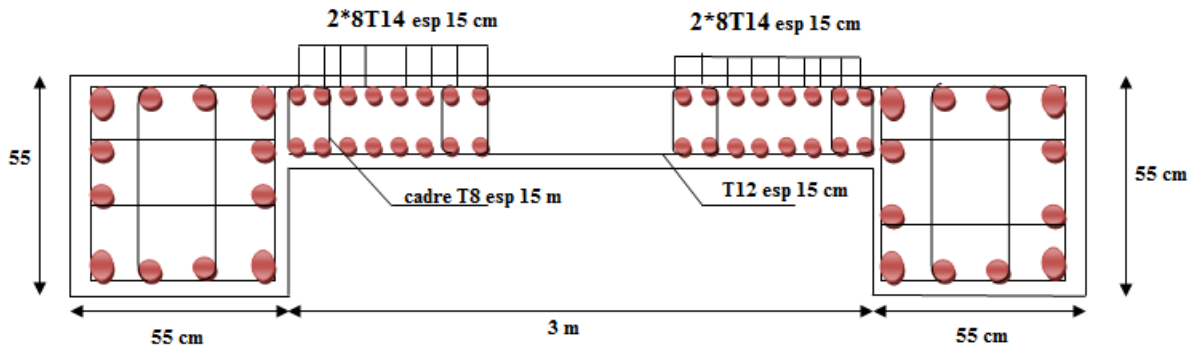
Détail de Ferrailage du voile (V2- V2'), coupe horizontale.
